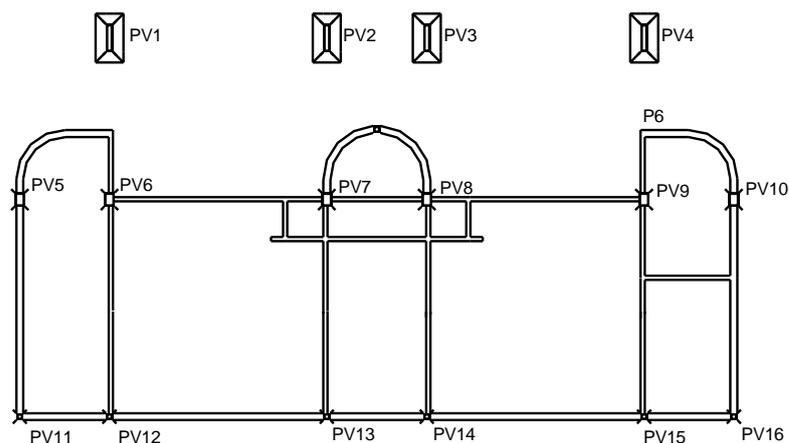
Planta de Forma Pavimento Térreo – Projeto de Ampliação
